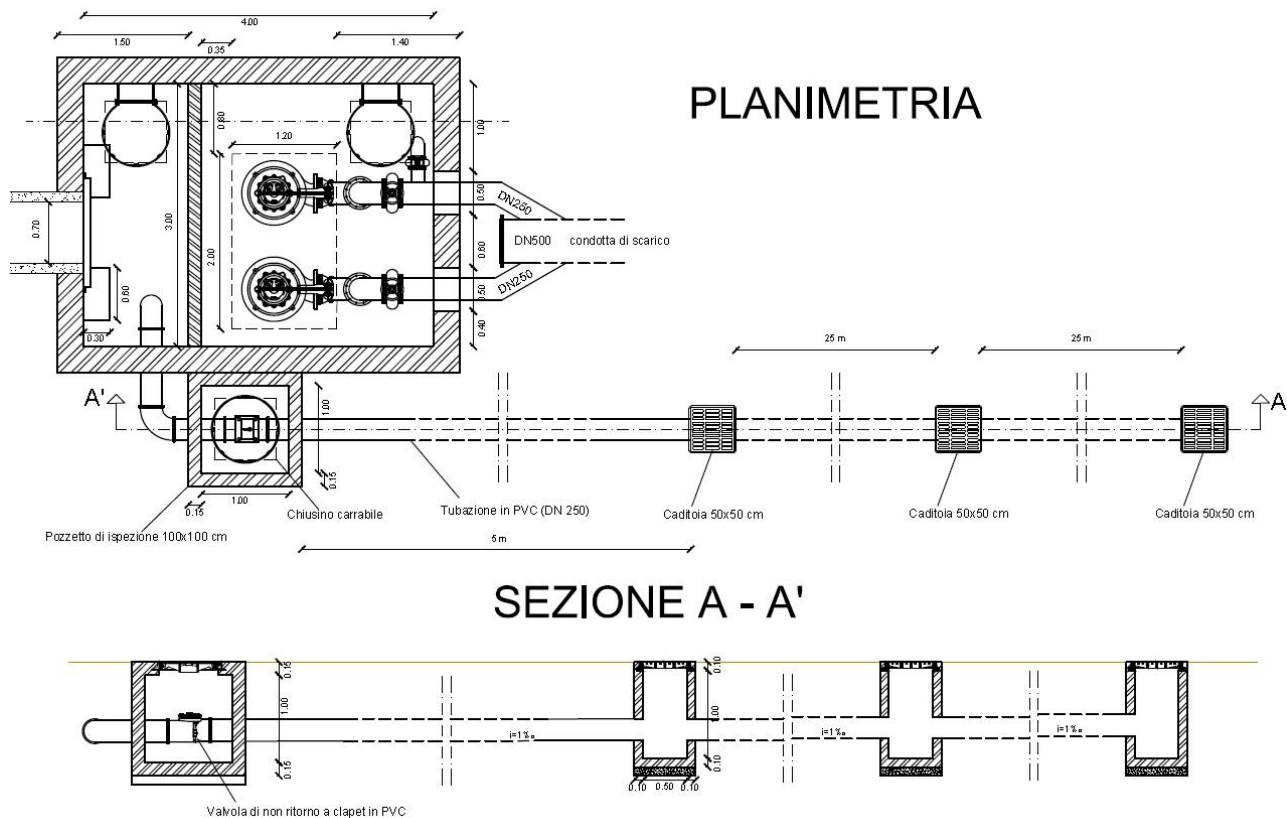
Stazione di sollevamento ‘Passo della Sentinella’: sistema di drenaggio delle aree limitrofe.
